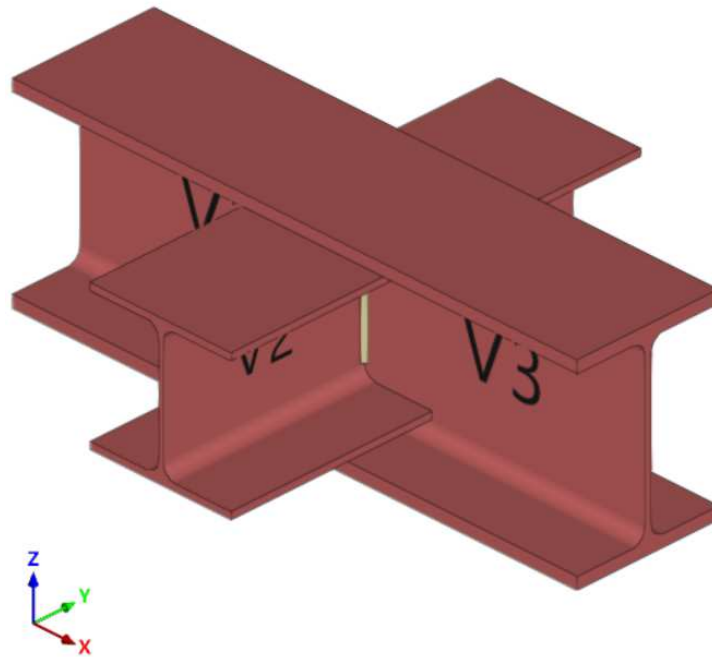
Unión Viga de carga-Viguetas (Fuente propia)
